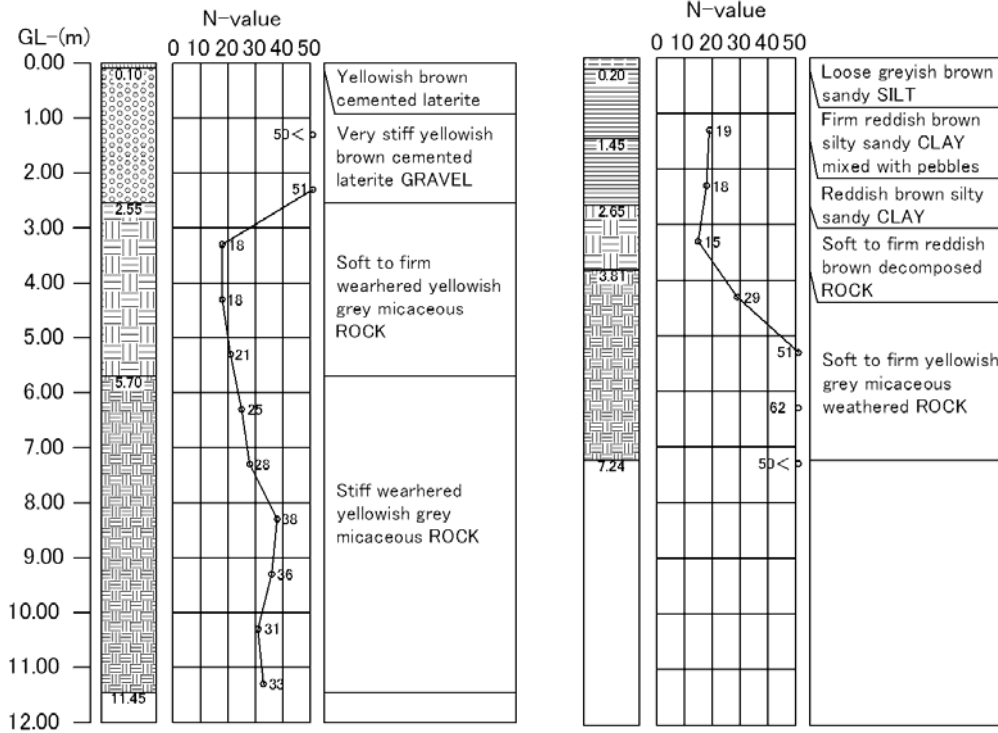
地質柱状図 (左:ムカンダ 右:サンテ)
